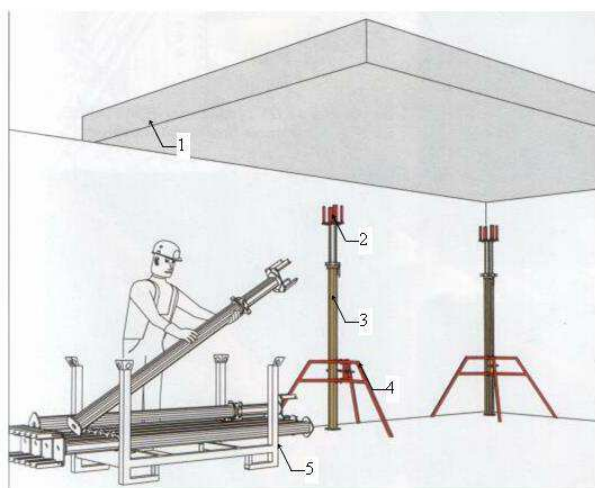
Демонтаж основных стоек: 1 – вновь возведенное перекрытие; 2 – унивилка; 3 – стойка; 4 – тренога; 5 – контейнер для складирования элементов опалубки
